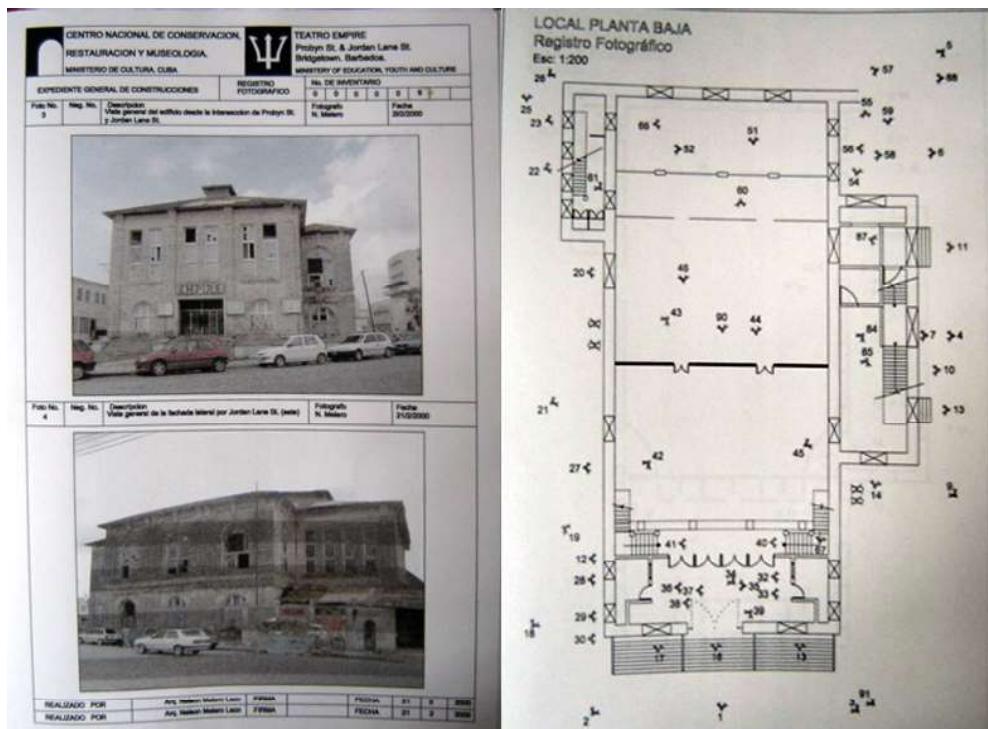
Por la izquierda la Planilla del Registro fotográfico para el levantamiento. Teatro Empire. Bridgetown. Barbados. Fuente (Melero, 2002). Por la derecha el plano de planta con la ubicación del registro fotográfico. Teatro Empire. Bridgetown. Barbados. Fuente: Melero, 2002.
